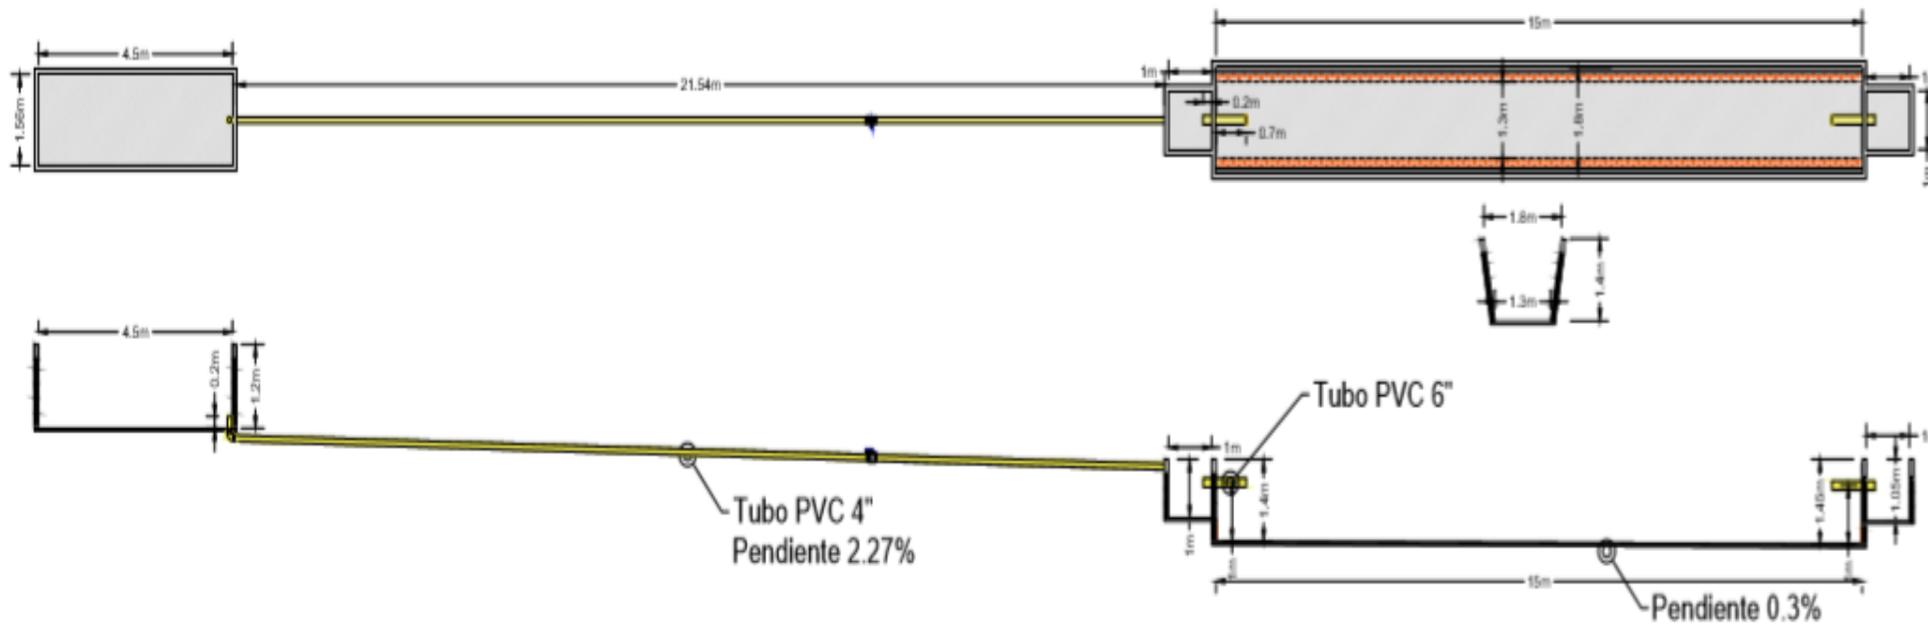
Diseño tanque de fermentación con dimensiones en planta y corte.
